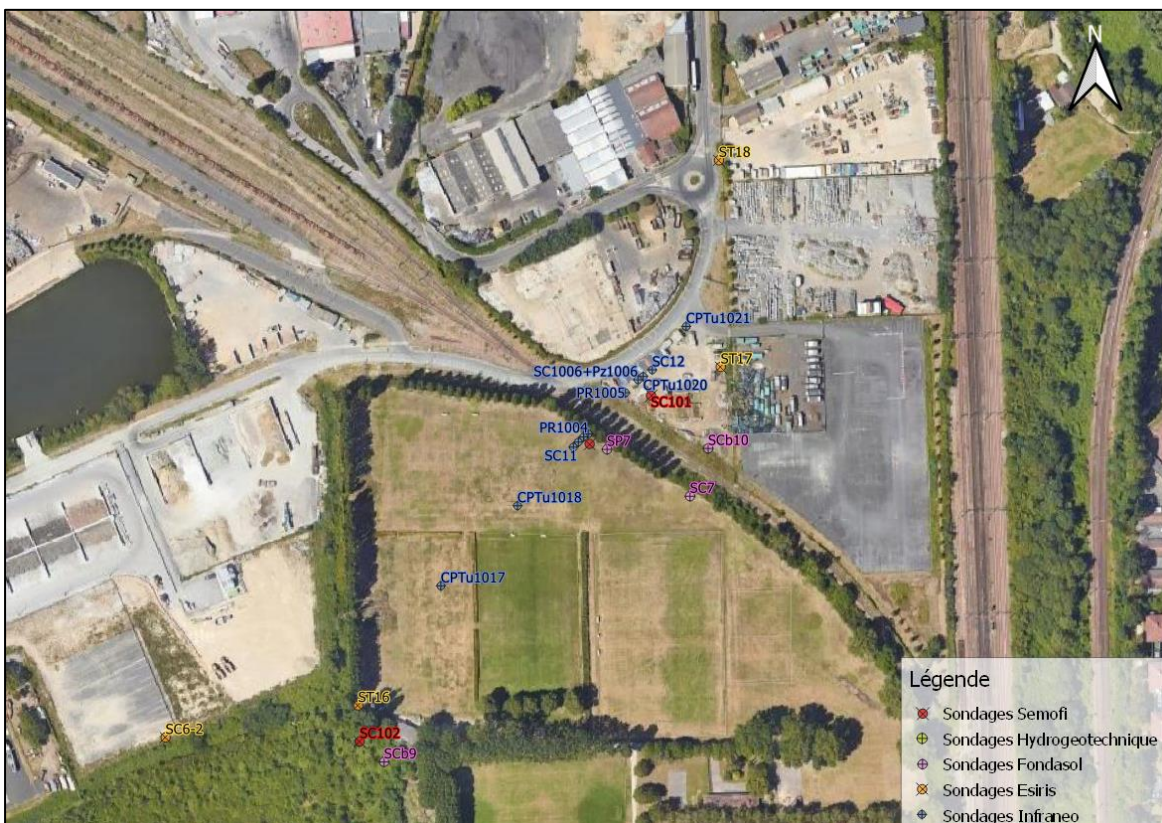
Extrait du plan d'implantation des sondages au droit du secteur OA Port (source : GINGER CEBTP)
